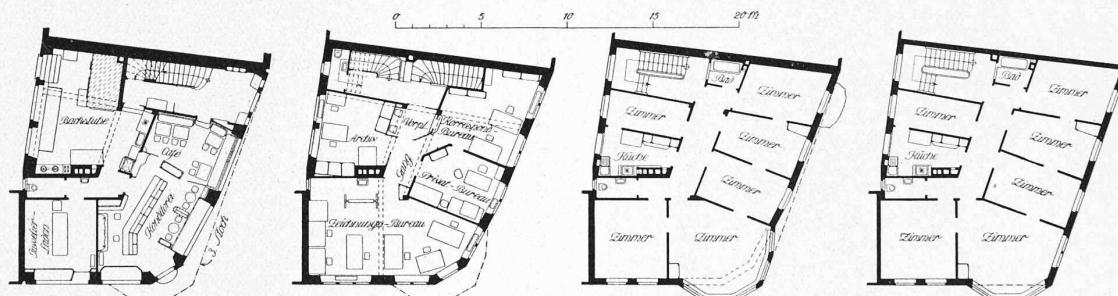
bis 5. Grundrisse vom Erdgeschoss, I., II. und III. Stock des neuen Hauses „zur Egge“. — Masstab 1:400.
